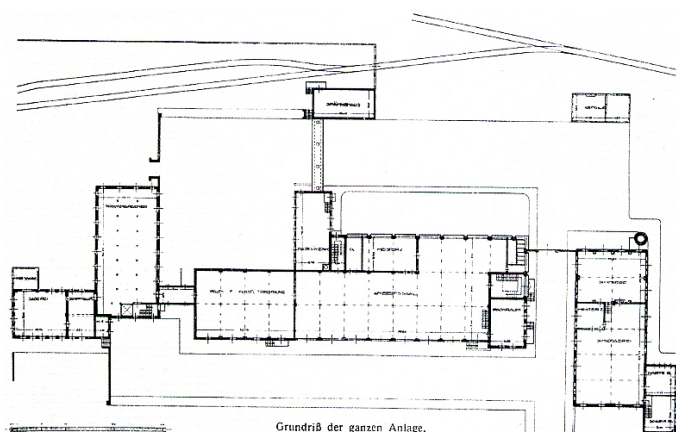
Planta do complexo proposta e construída por Walter Gropius e Adolf Meyer em 1911 (in AB).
